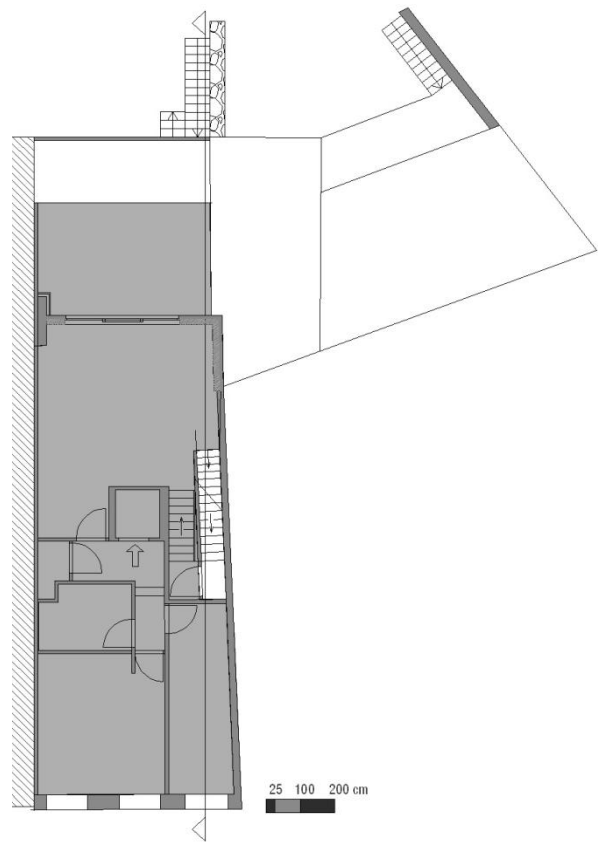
Plan du 4<sup>e</sup> étage (Source : Draps E., 2010)
